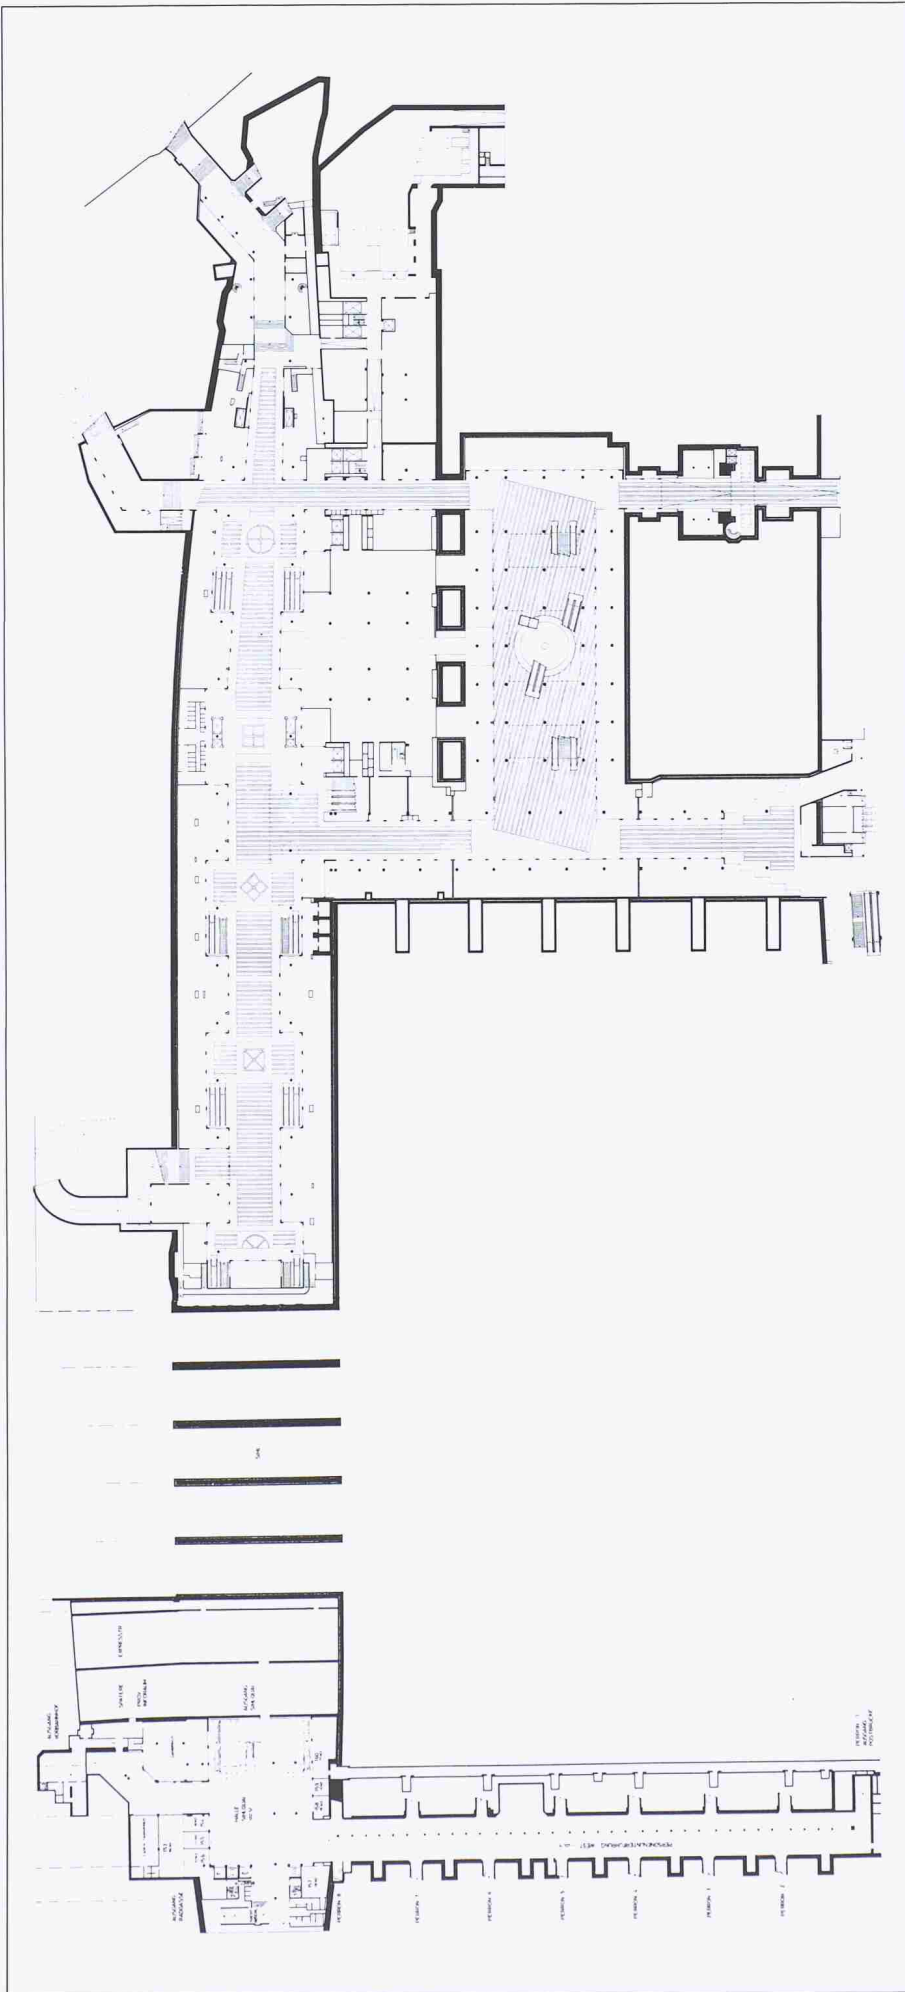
Grundriss Fussgängerebene (minus 2)
